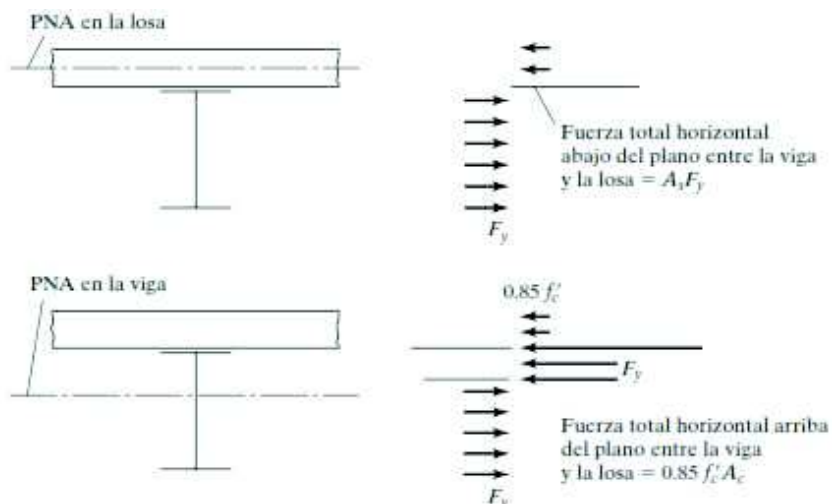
Fuerzas Horizontales actuantes sobre la sección.
